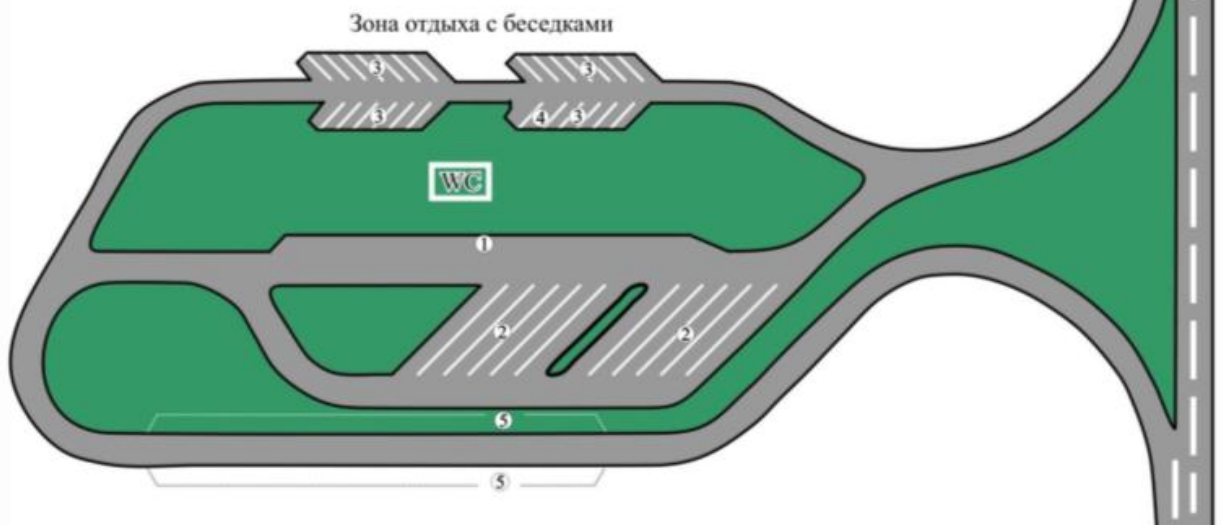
Пример (схема) размещения площадки для отдыха
